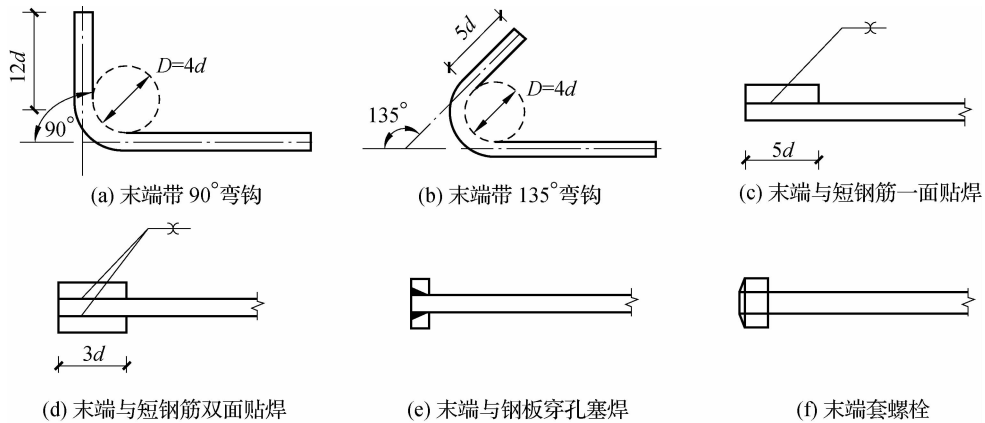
钢筋弯钩与附加机械锚固形式及构造要求
